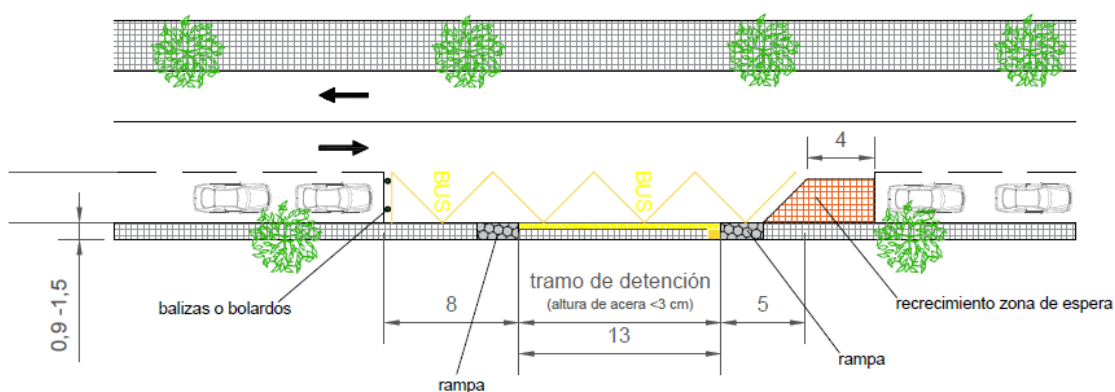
Parada urbana en carril de aparcamiento en cordón (autobuses de hasta 13 m) con apartadero excepcional en acera estrecha y rebajada
